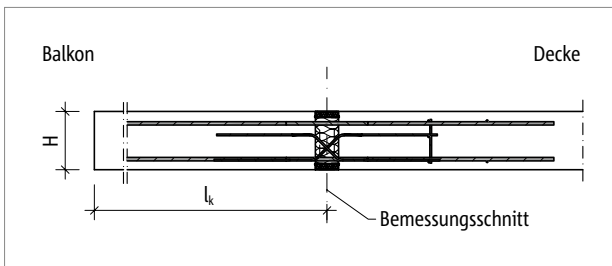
Schöck Isokorb® T Typ DP: Statisches System
